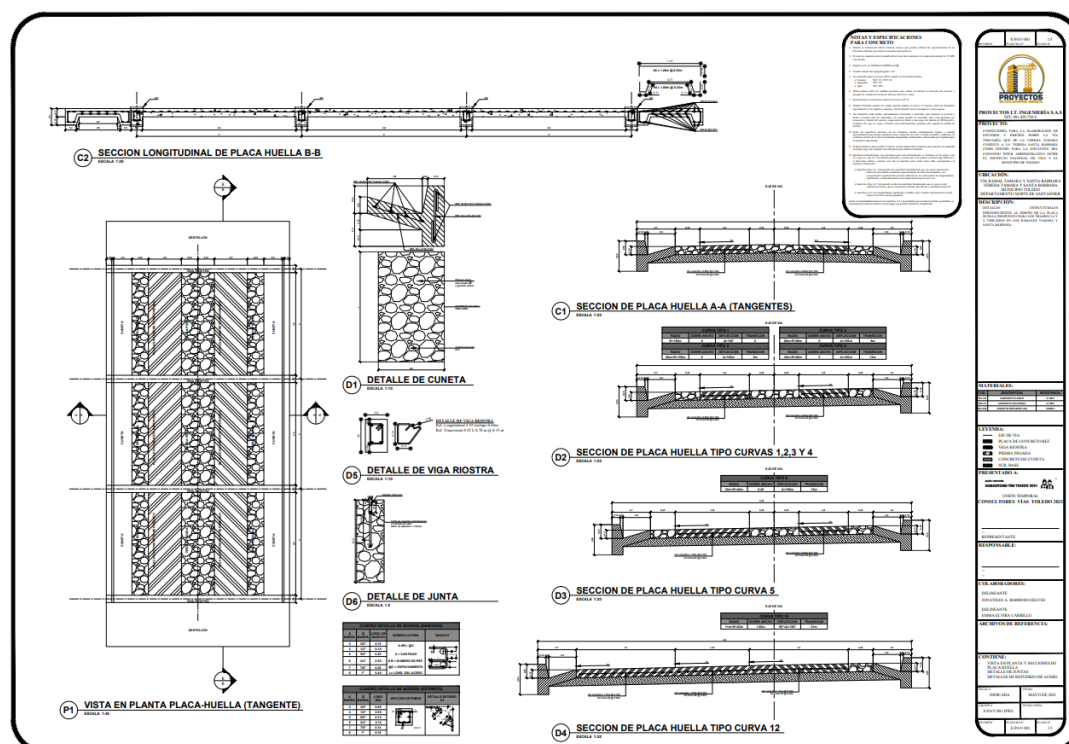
Detalles estructurales de placa-huella fuente (propia).
